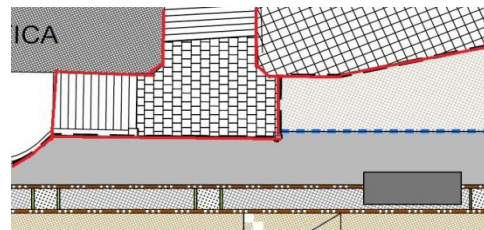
Pavimento na entrada da Igreja de Benfica [76]
